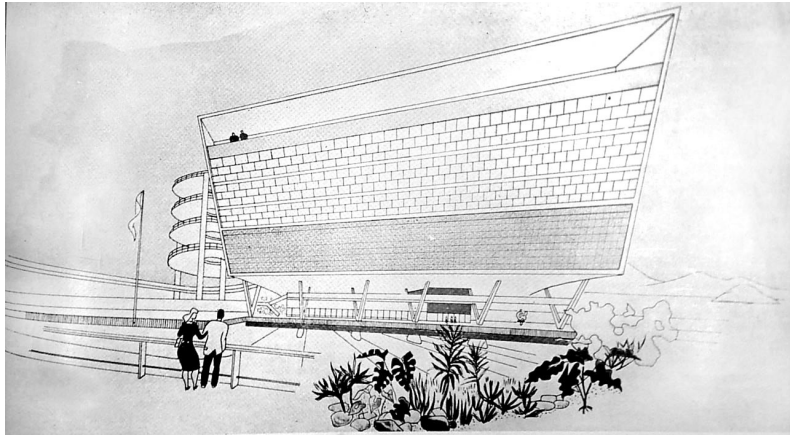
Fachada Praça Mauá. Fonte: Revista Habitat, 1955.
